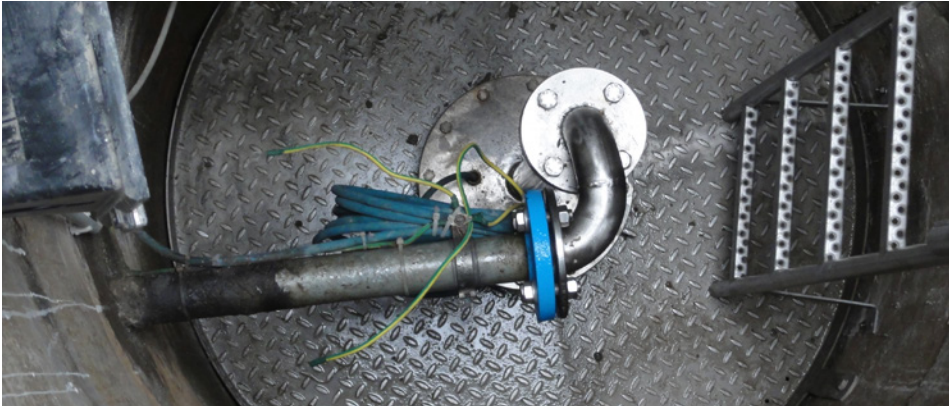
Fachgerecht ausgebauter Schachtbrunnen mit Edelstahlabdeckung und Pumpensitz
